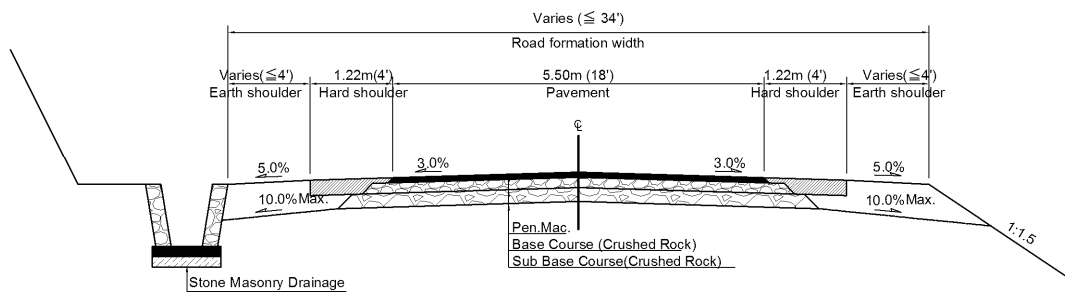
平地部の標準横断面図 (新設瀝青舗装: 5.5m)
